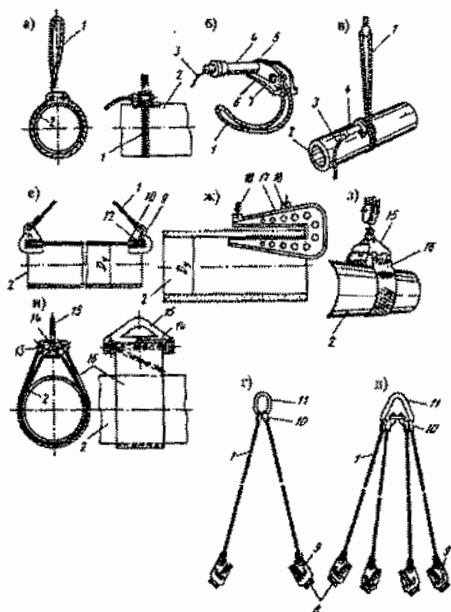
Грузозахватные приспособления, применяемые при строительстве трубопроводов; а - строповка трубы универсальным стропом с приспособлением для дистанционной расстроповки; б - полуавтоматический строп "удавка"; в - строповка трубы полуавтоматическим стропом; г, д - двух- и четырехветвевые стропы; е - шарнирный торцевой захват для асбестоцементных труб; ж - монтажная скоба для железобетонных труб; з - мягкий строп (полотенце); и - строповка мягким захватом; л - трос несущий; 2 - труба; 3 - тросик для выдергивания фиксатора; 4 - фиксатор-замок; 5 - щека; 6 - оворная плита; 7 - палец; 8 - скоба; 9 - захват; 10 - коуш; 11 - сержа; 12 - мягкие прокладки; 13 - стержни; 14 - привод для вытягивания полотна из-под трубы; 17 - монтажная скоба; 18 - устройство для подвески трубы
